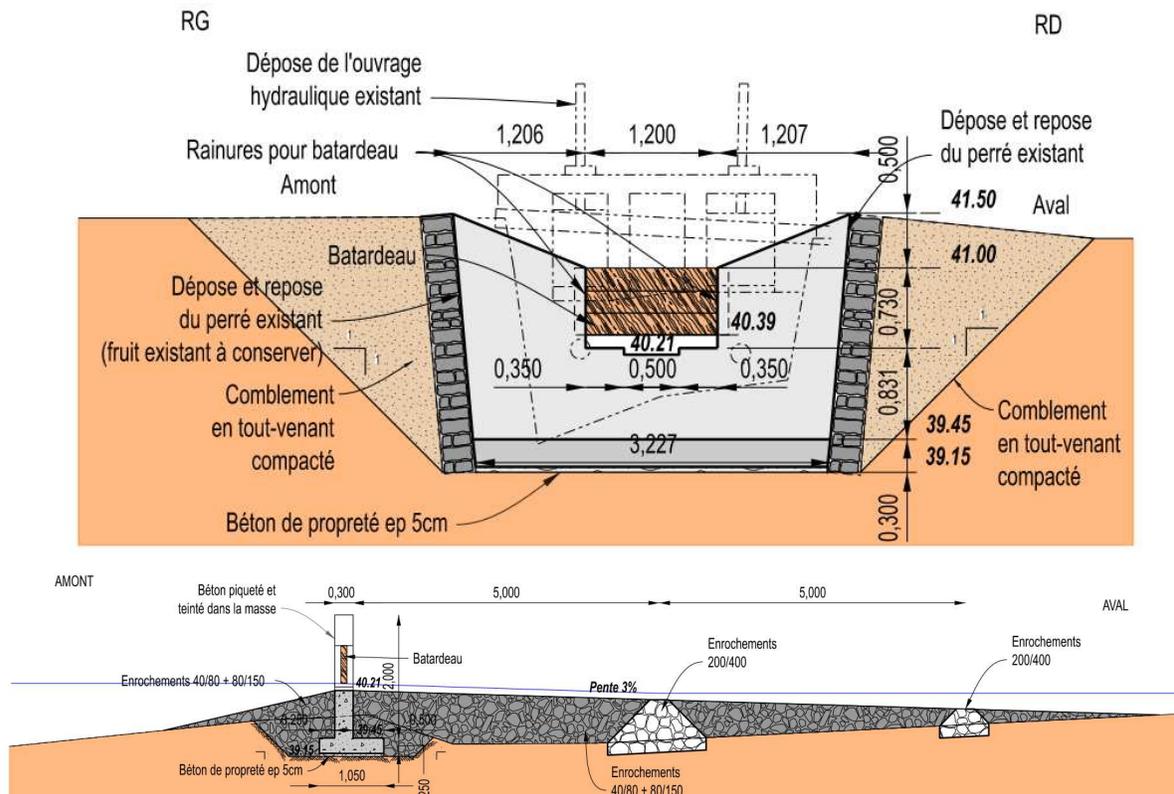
coupes de l'ouvrage de prise d'eau du bras du Perray (plan n°15)
